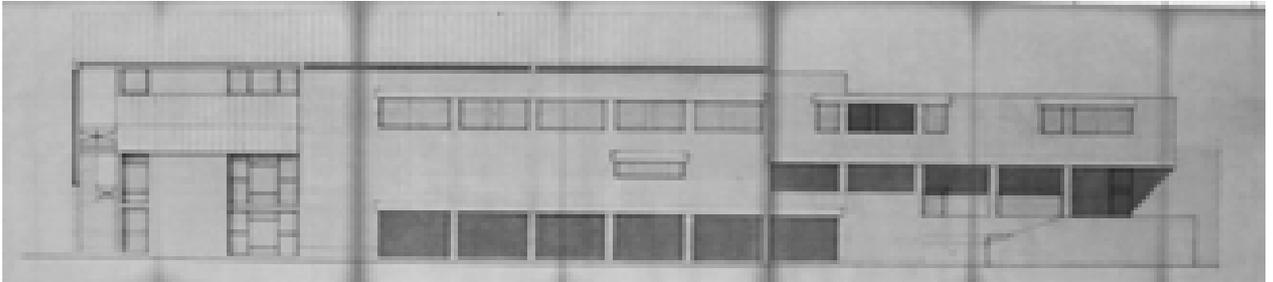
Prospetto, Est –08/12/1981 (AABS-1996.645)
